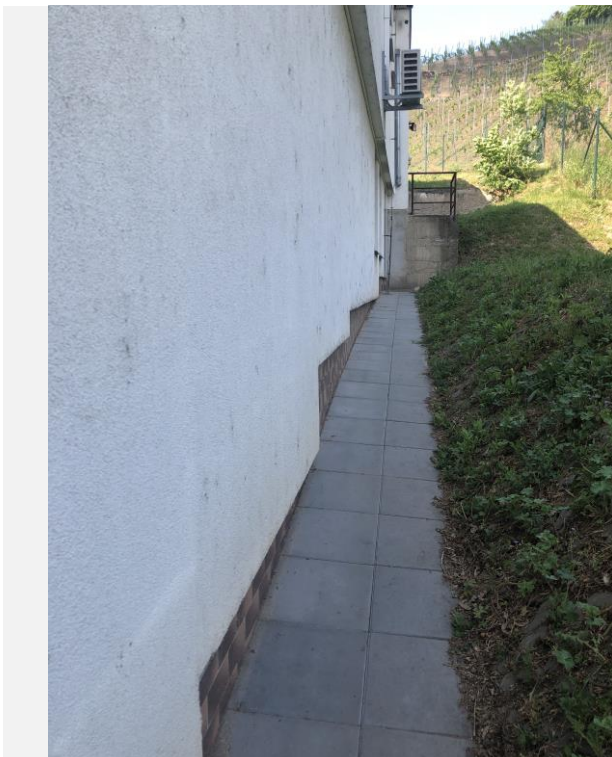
FOTO Jižní fasáda, šachta pro dešťové srážky
